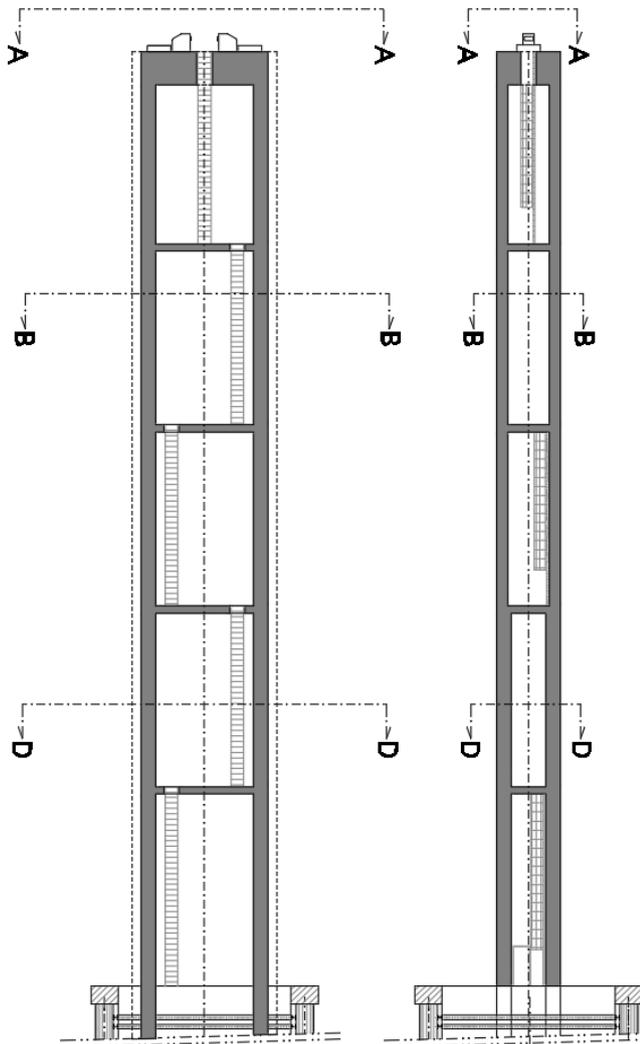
Nuova Pila 8 – Sezioni in elevazione longitudinale (in dir. asse viadotto) e trasversale
